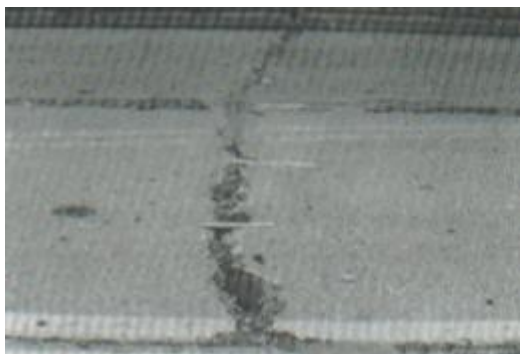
Grietas lineales de alta severidad en losa de concreto simple.
